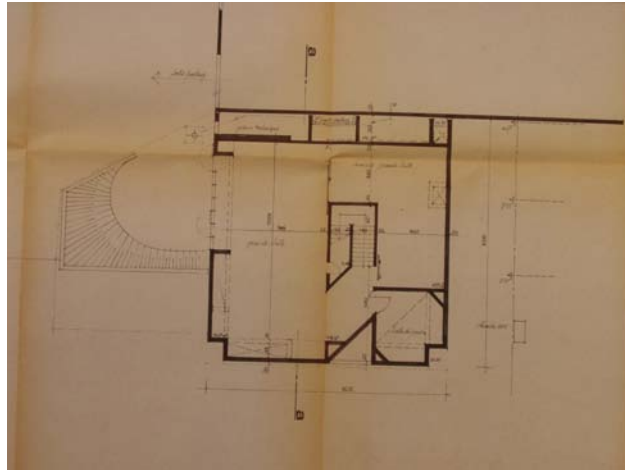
Plan rez-de-chaussée, avril 1978 (AHDL Carton CDAS)
